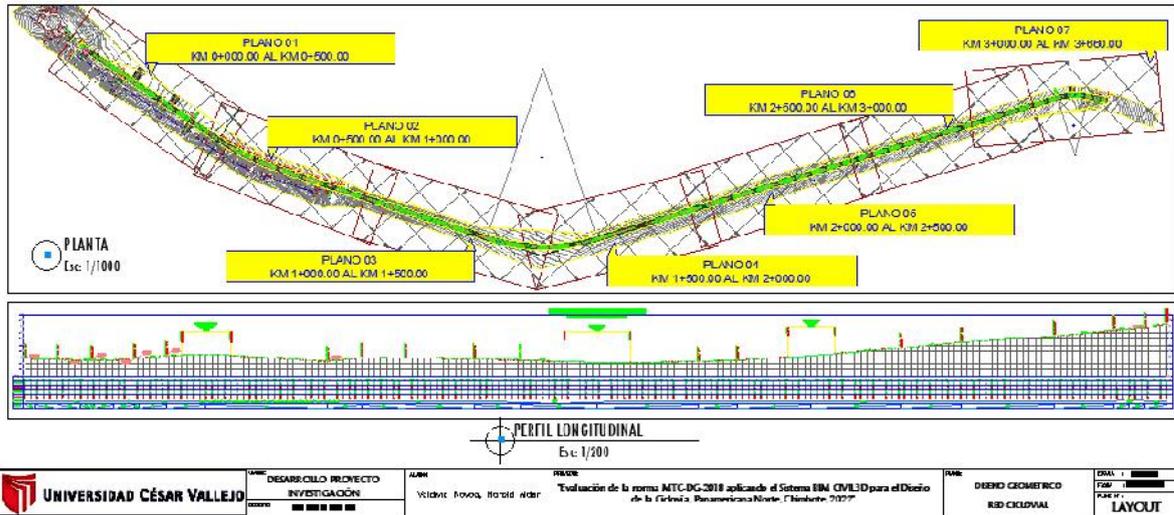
Layout General: Planta – Perfil Longitudinal: Km 0+000 al Km 3+660.00
